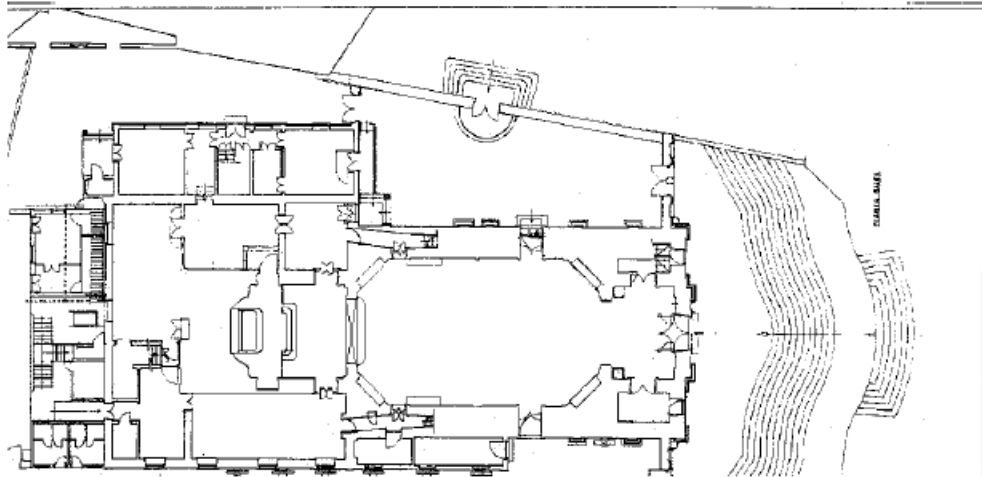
Planta da igreja de Santo Ildefonso (Porto) [3]
